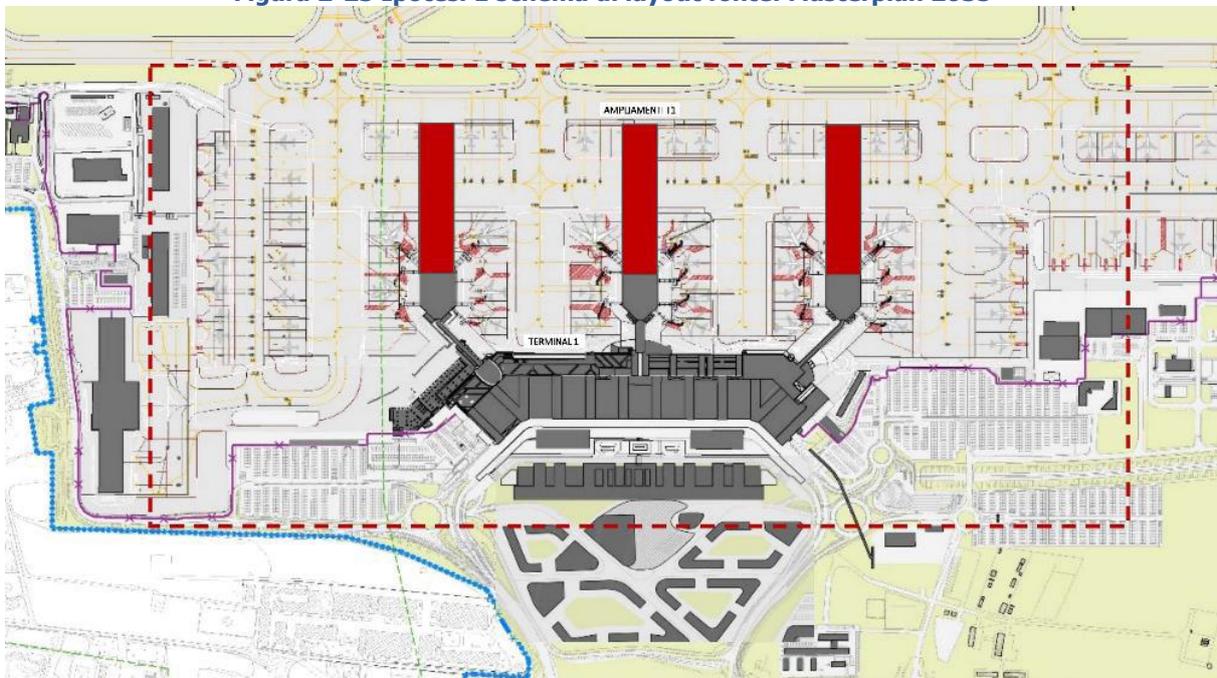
Ipotesi 2 schema di layout fonte: Masterplan 2035
